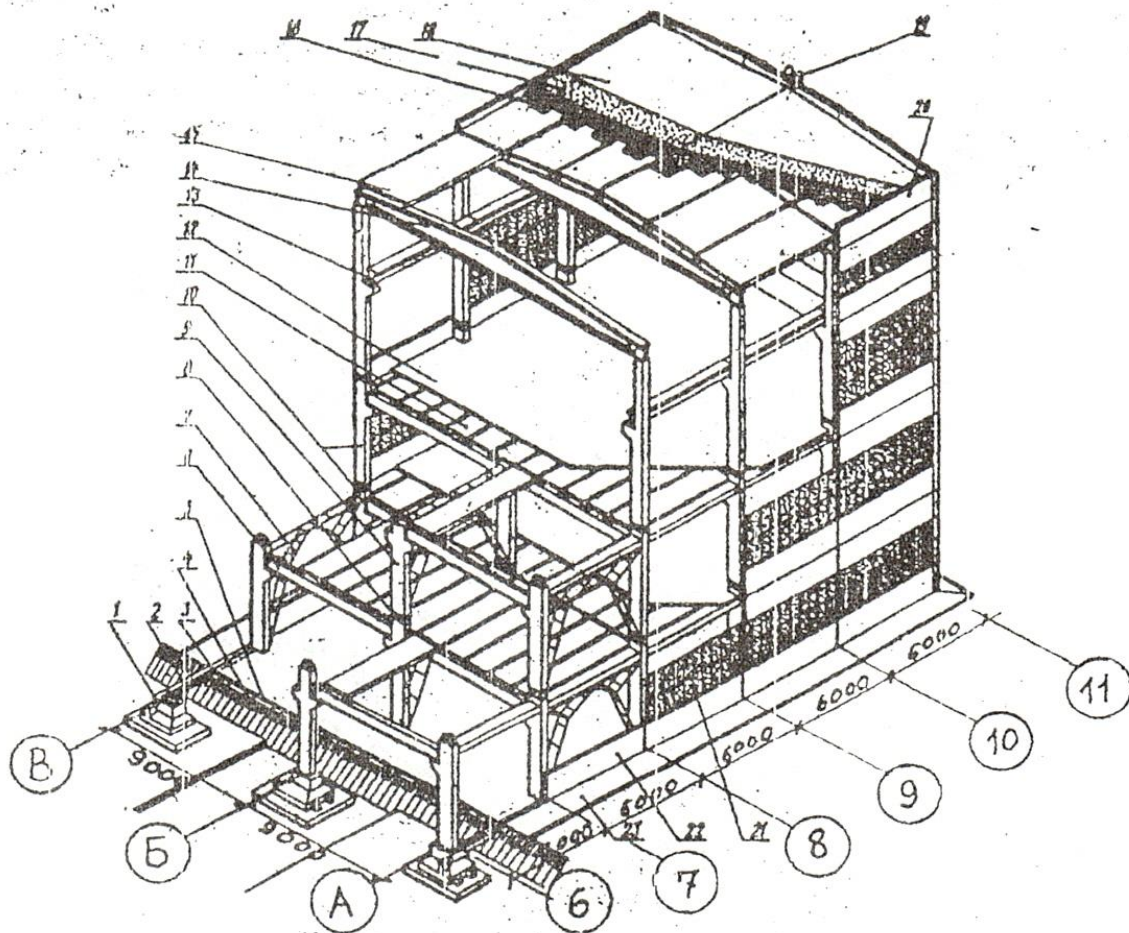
Многоэтажное промышленное здание с мостовым краном:
